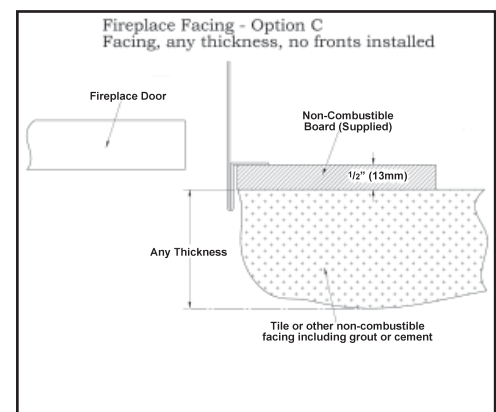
Option 3 - Tout foyer sans installation de façade optionnelle.
